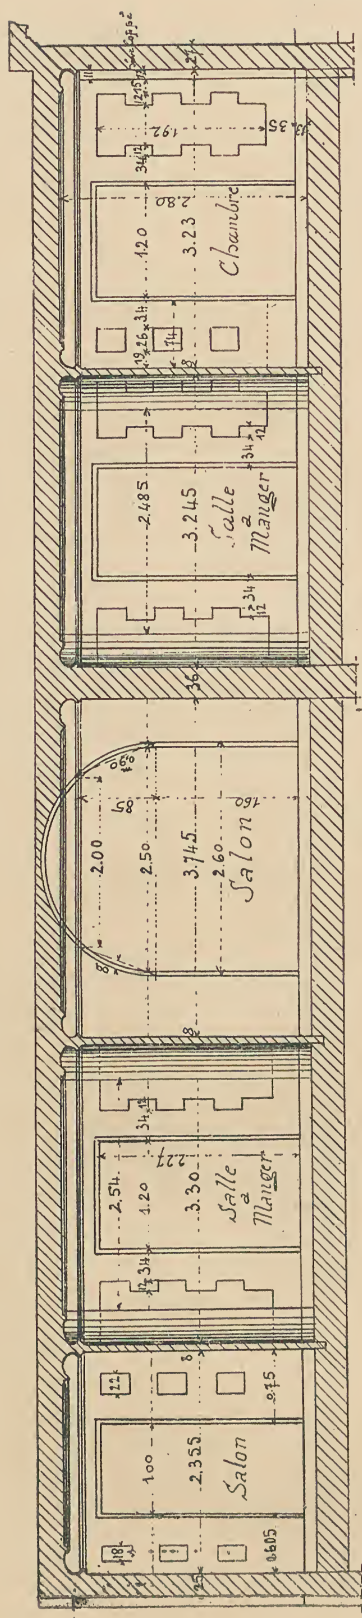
Élévation intérieure du mur de façade au 6<sup>e</sup> étage sur le boulevard Rochechouart.
